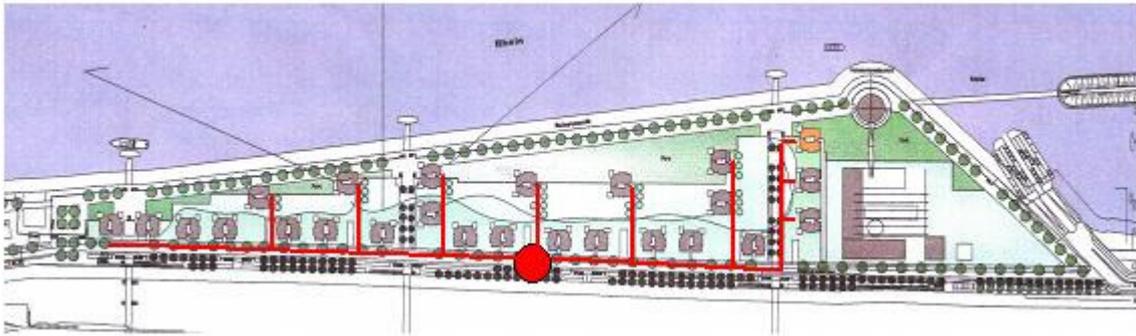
Lageplan mit Holz-Nahwärmenetz
